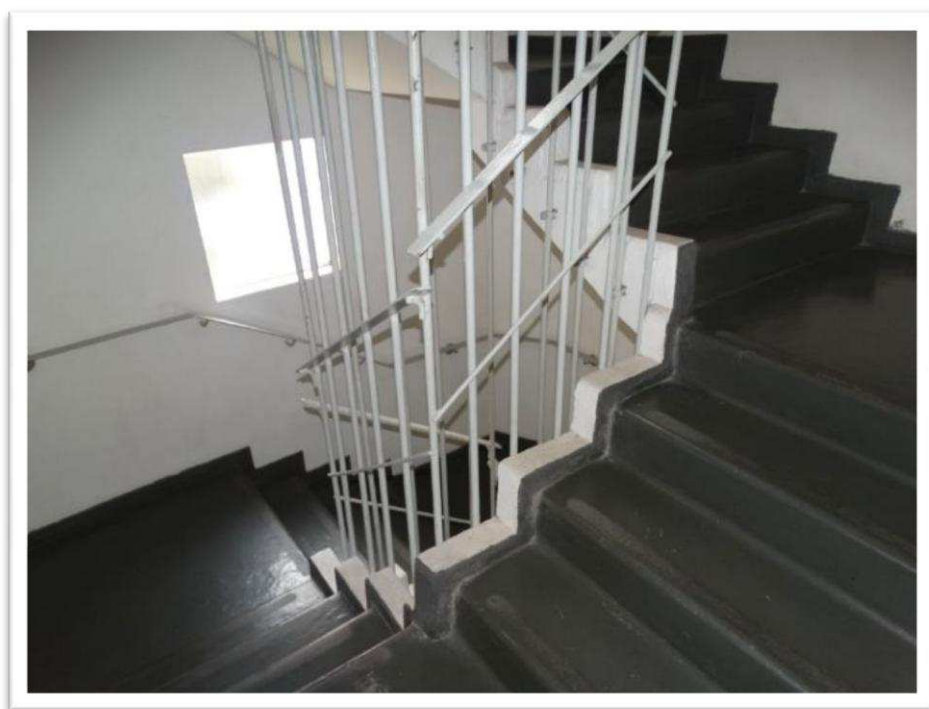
Vista da caixa de escadas do bloco 17.
